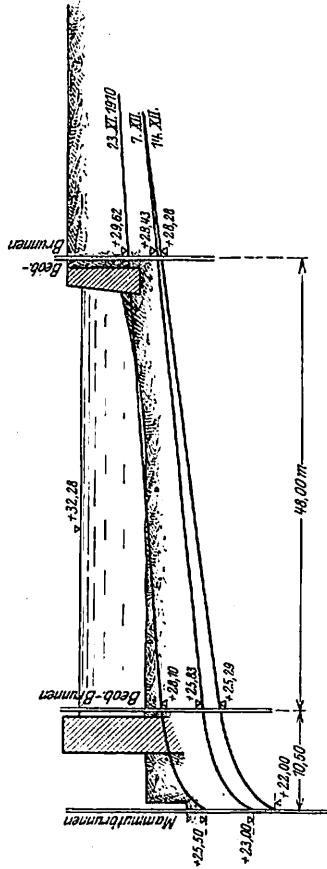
Spreetunnel Inselbrücke (Abschnitt I); beobachtete Spiegelsenkung vor Kopf (quer zum Strom) (nach Enzweiler).
